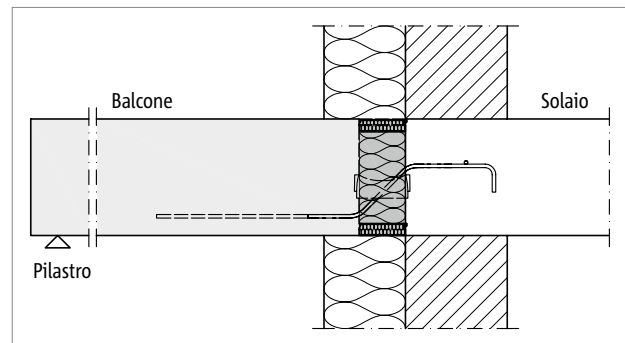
Schöck Isokorb® T tipo Z, Q: sistema di isolamento a cappotto
